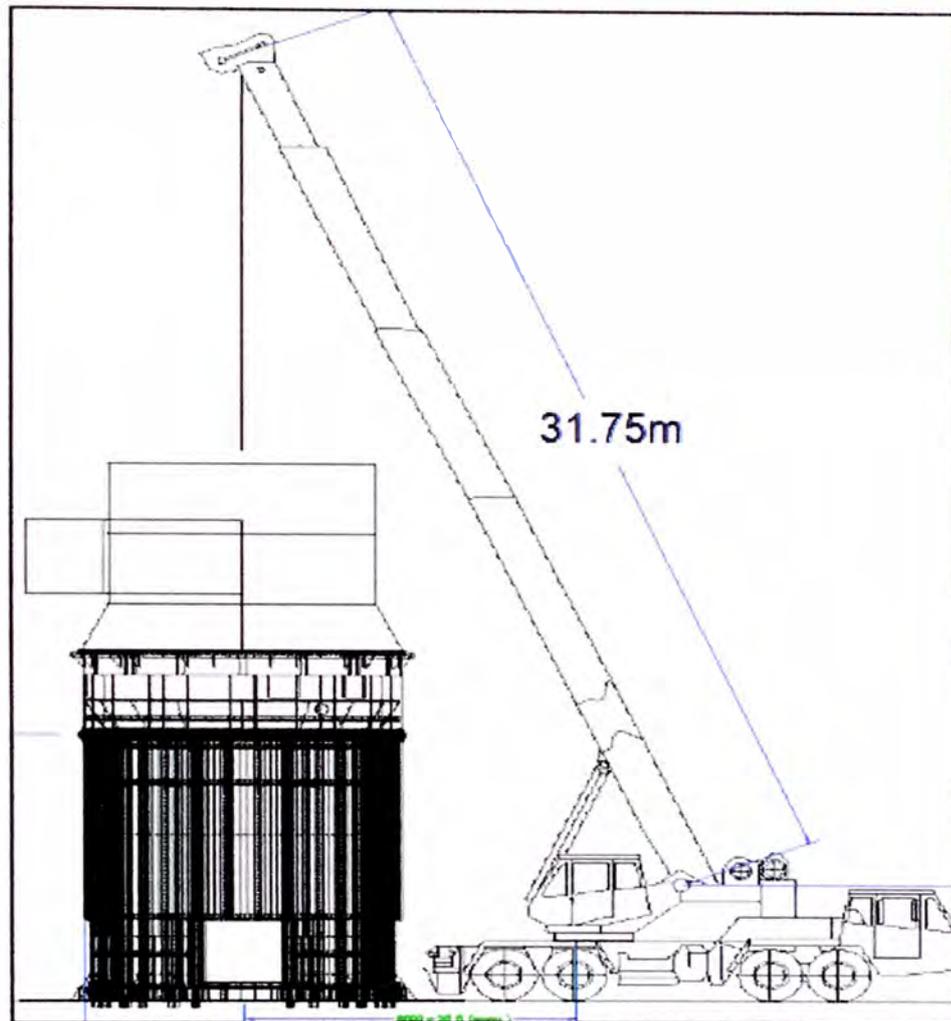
Dimensiones para el Montaje del Paso 04
